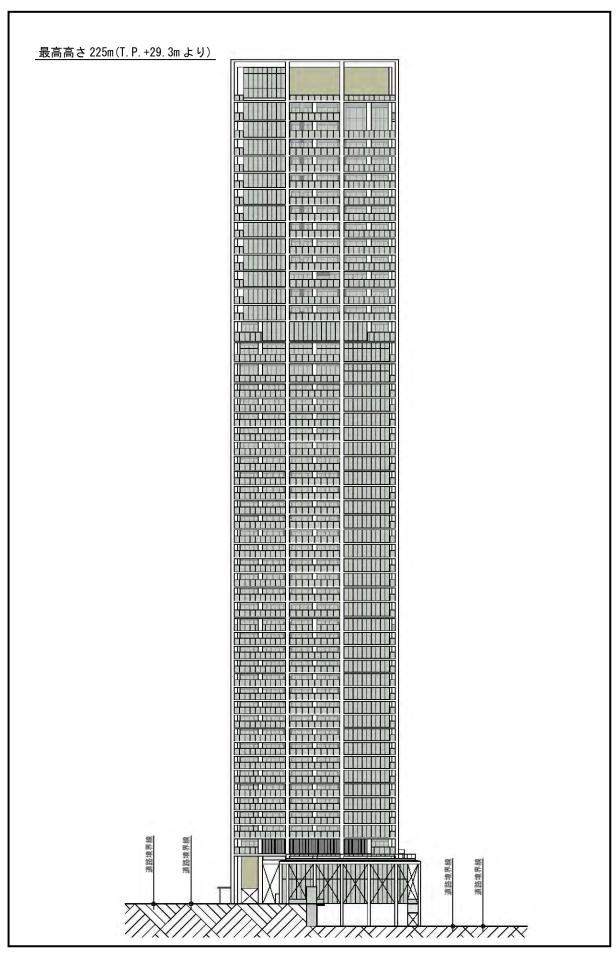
(3) 立面図 (南立面図 S=1:1,000)
